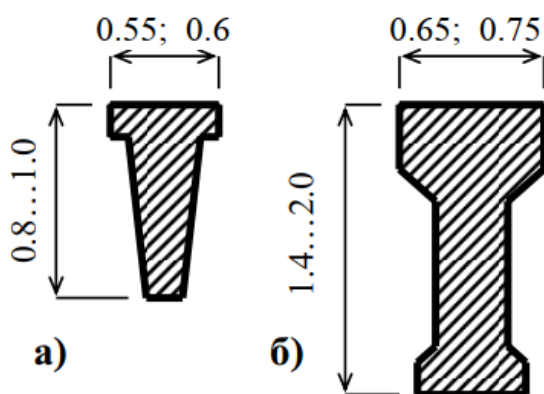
Види підкранових балок за перерізом: а) таврово-трапецієдальні; б) двотаврові
